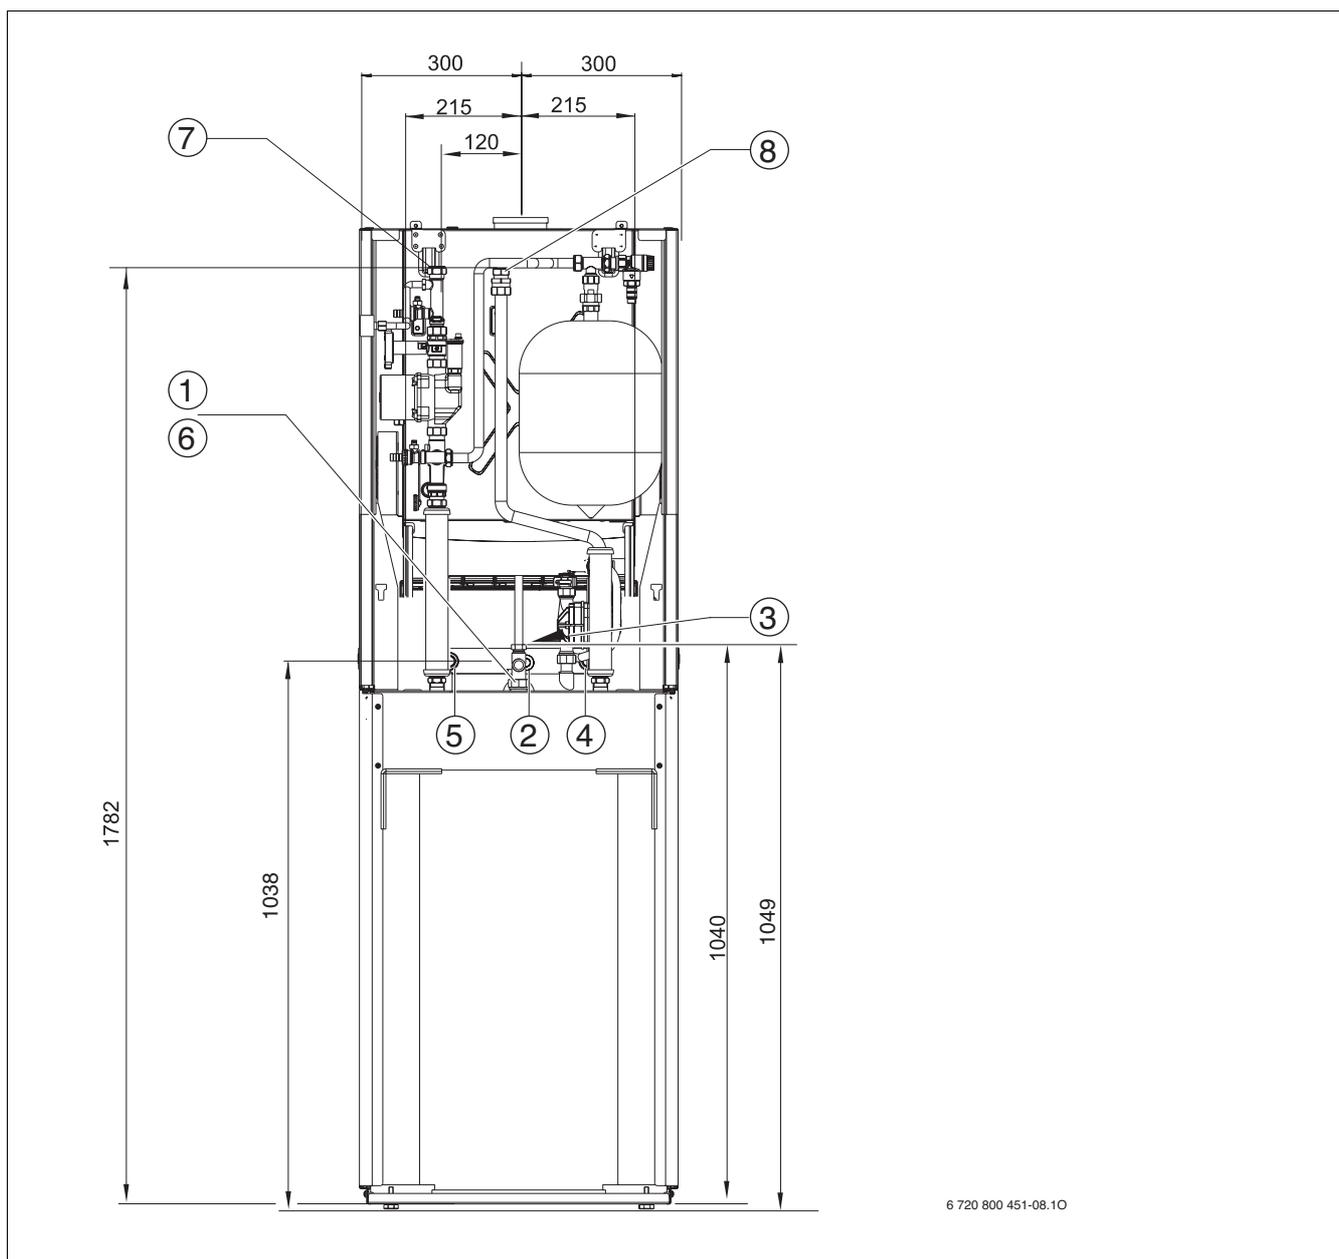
Dimensioni e attacchi per GB172-.. T210SR (misure in mm)
